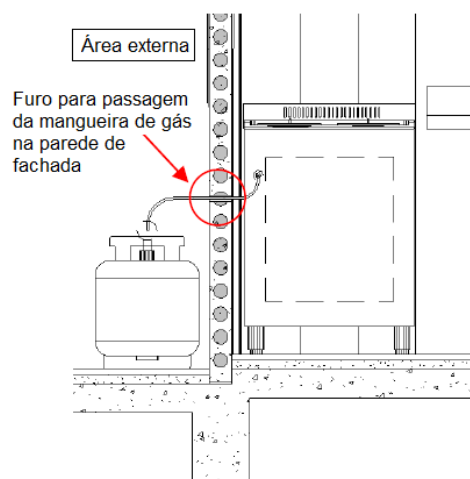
Ilustração do furo transversal na parede de fachada, perpendicularmente, para passagem da mangueira de gás. (Sem escala).
